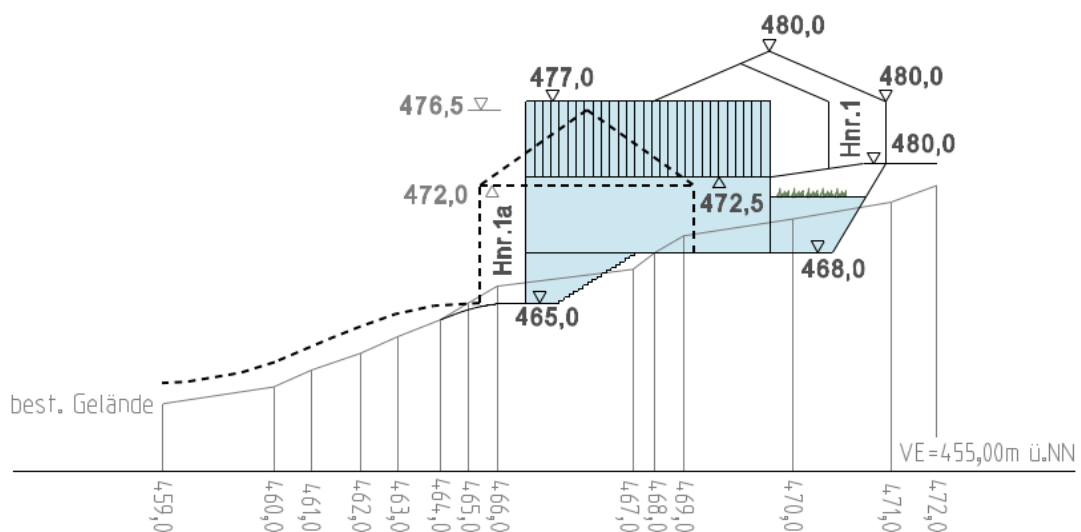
Systemschnitt künftiges Höhenniveau Neubebauung im Vergleich zu Bestandsstrukturen
